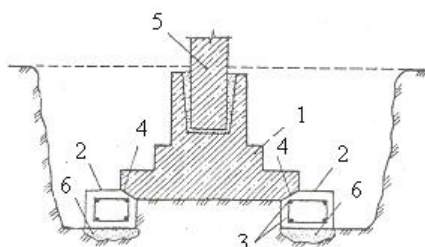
Устройство железобетонной рамы для увеличения площади фундамента стаканного типа:
